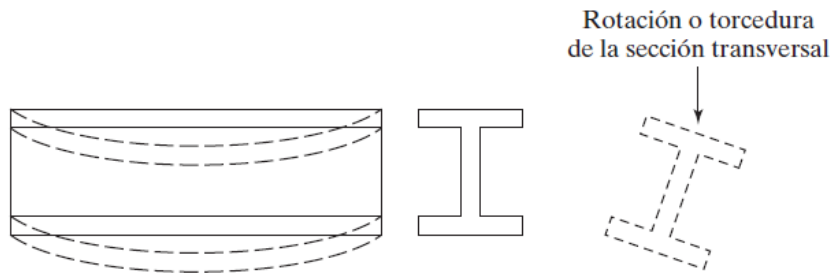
Pandeo de torsión lateral de una viga simplemente apoyada
